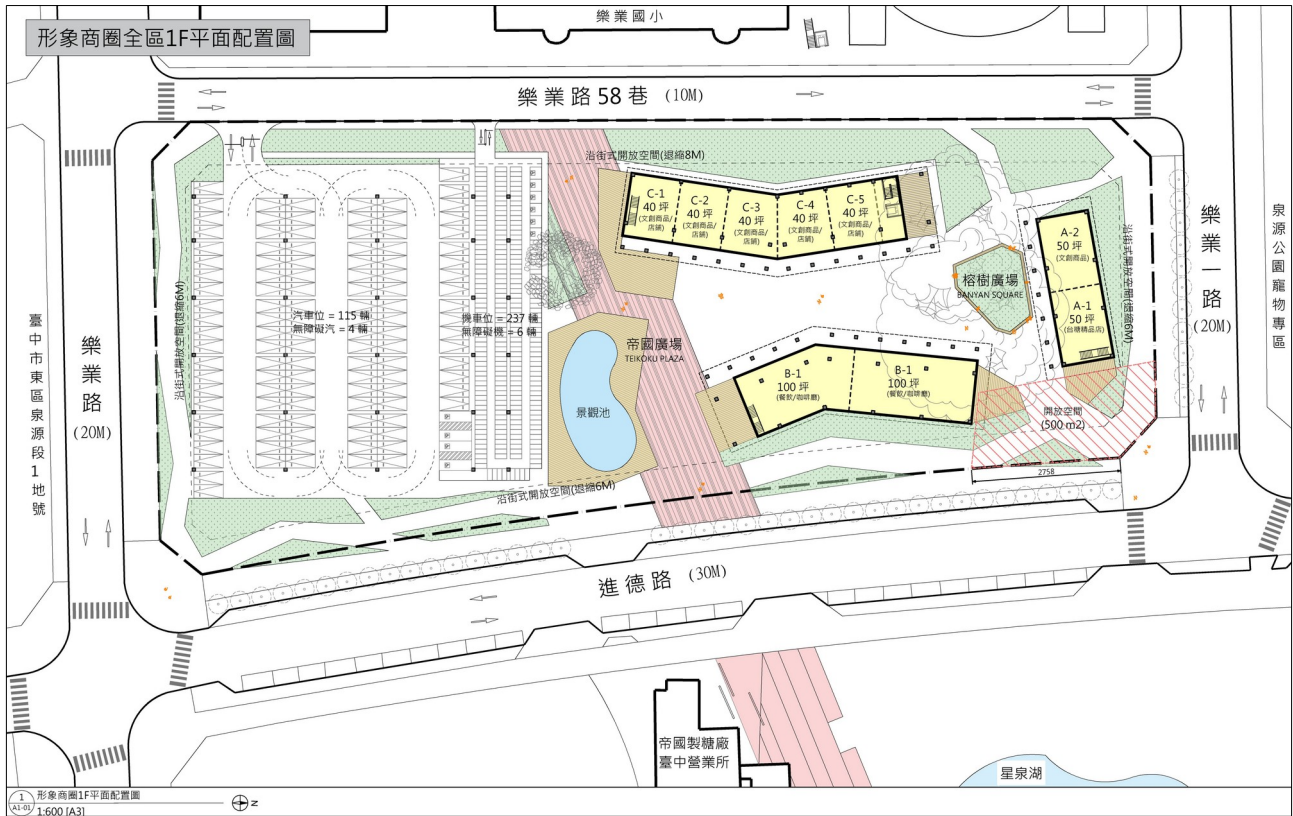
形象商圈 1 層平面示意圖(S : 1/600)
